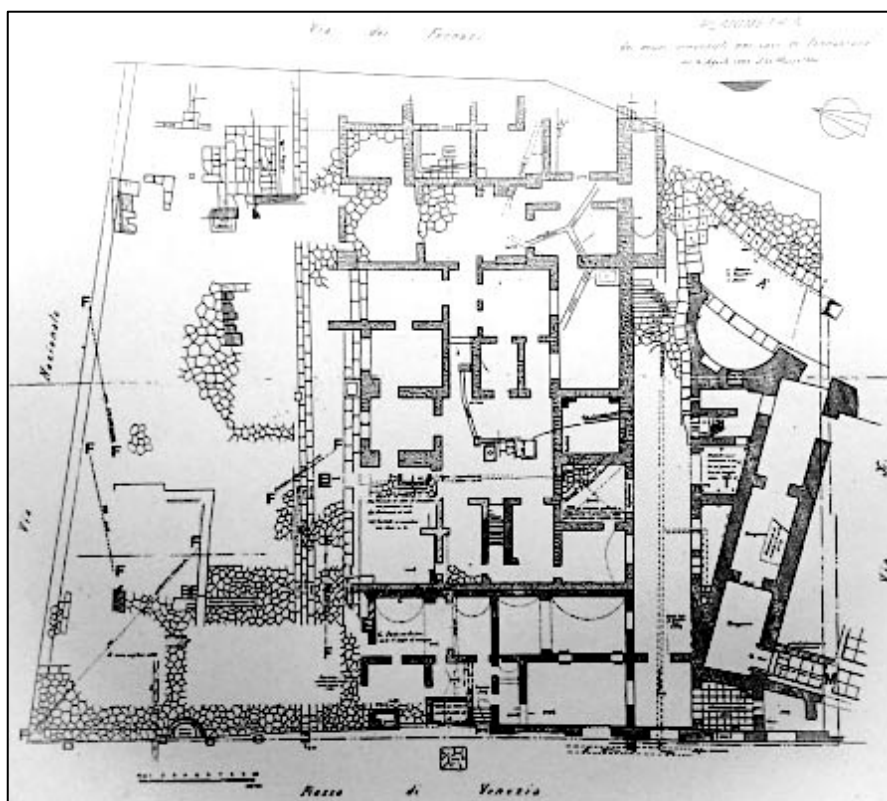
Planimetría de las excavaciones de 1902 bajo el Palazzo Generali. Gatti 1934.
